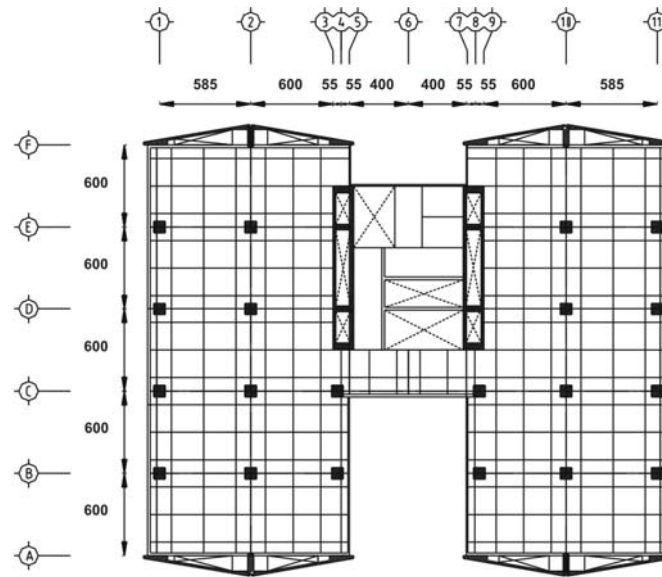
planta tipo del edificio Niveles 4 al 16
